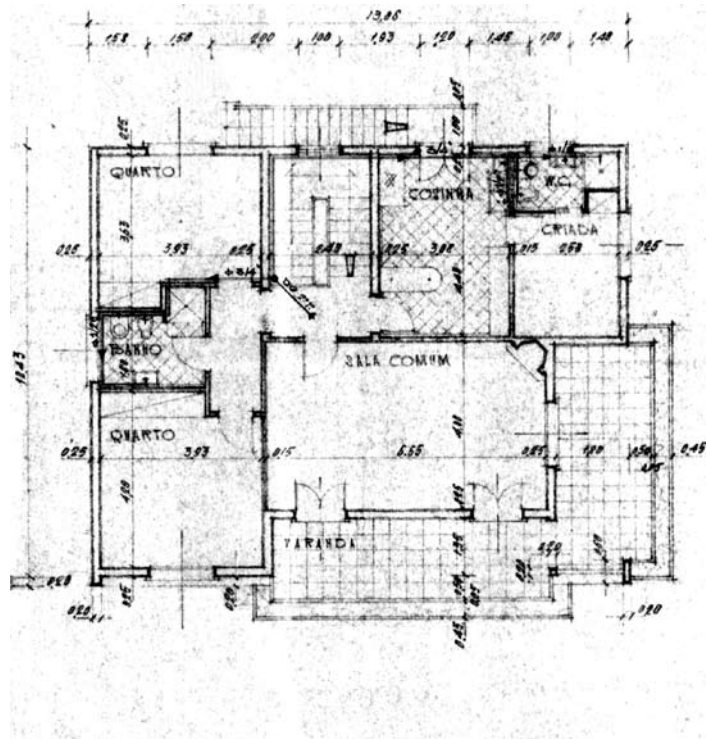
Casa Mª Filomena Carrega , António Egêa, 1958. Planta piso 1.
